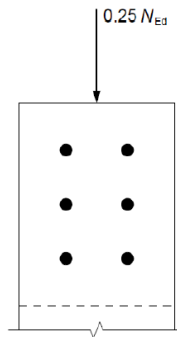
Schéma de la vérification de la section de la semelle.
